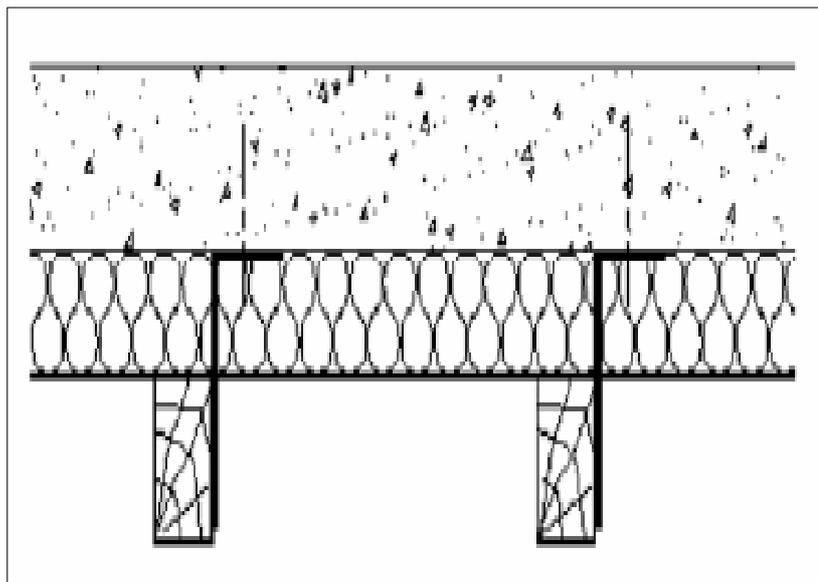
Sistema de colocación del aislante entre muro y estructura que recibe el revestimiento
